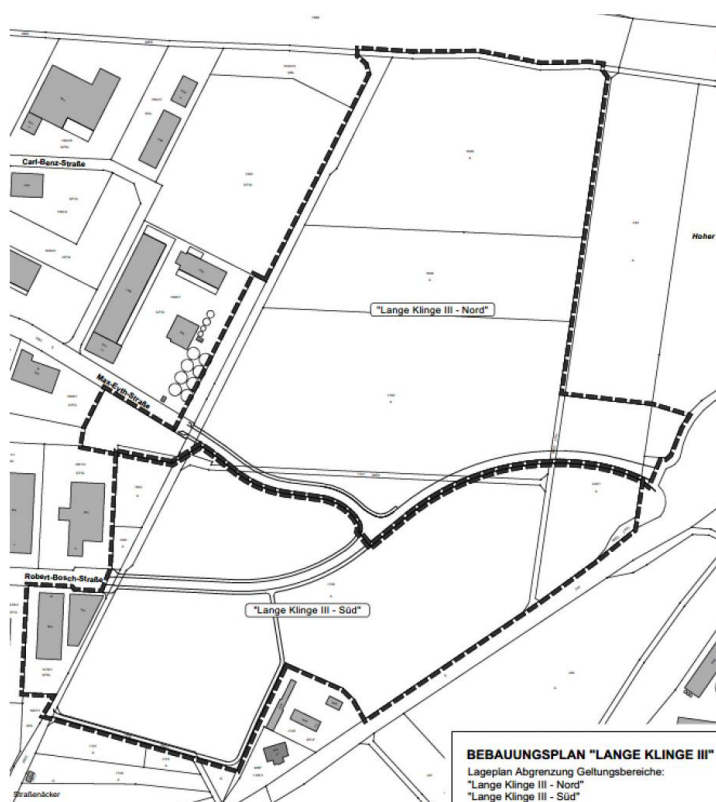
Bebauungsplan mit den Bauflächen Nord und Süd (Quelle: Bit Ingenieure³).
